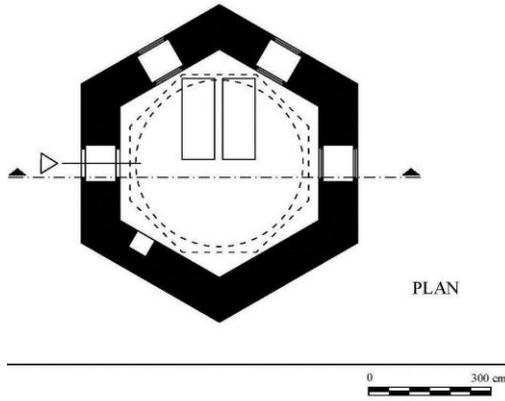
مسقط أفقي لتربة محمد أفندي في استانبول عن:
